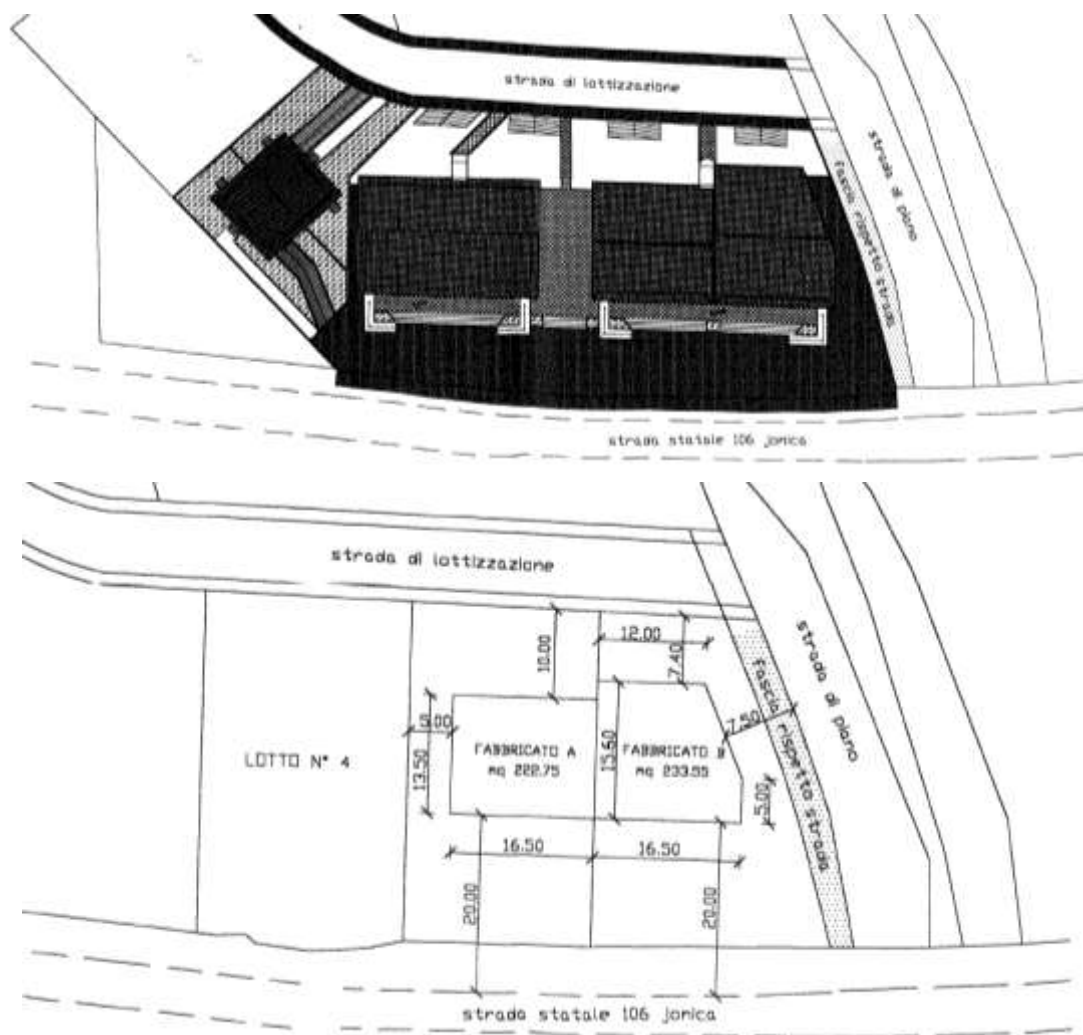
Stralcio TAVOLA 3 di cui al Permesso di Costruire n.25 del 20/11/2004 – Planimetria generale
